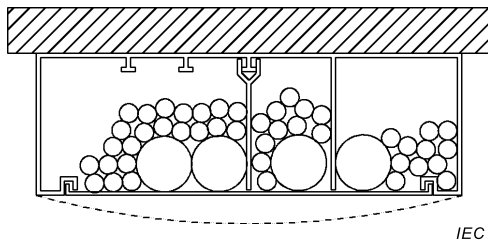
SG/SCP de section transversale rectangulaire ou similaire
